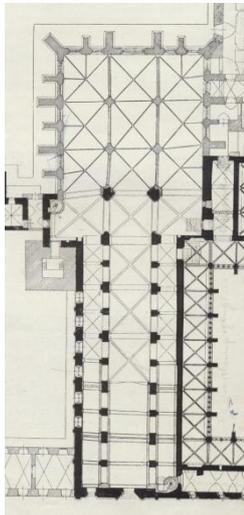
Heiligenkreuz, Stiftskirche, Grundriss, Chor 1295
